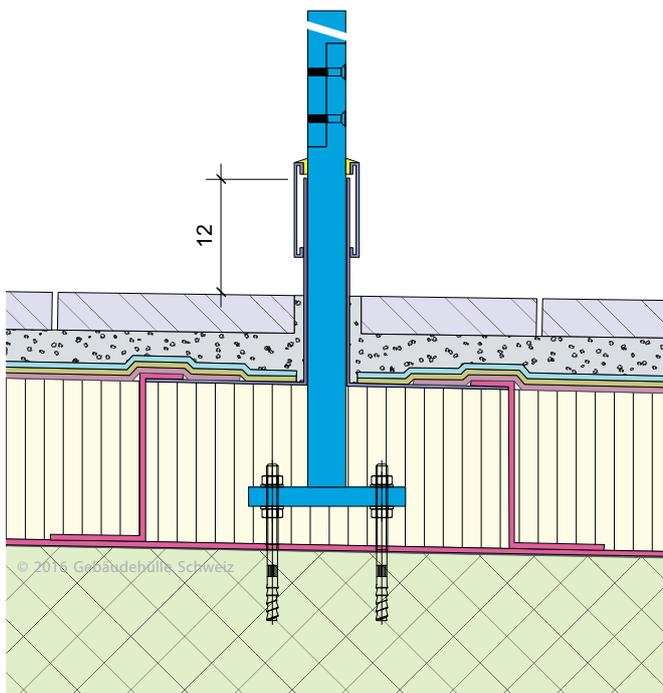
Raccordement d'étanchéité de console de garde-corps ouvert en haut, surfaces adhésives voir Fig. 12 et manchon de bande de recouvrement autour du montant. Le colmatage de la surface adhésive peut être fait de manière linéaire sur toutes les consoles ou individuellement.
